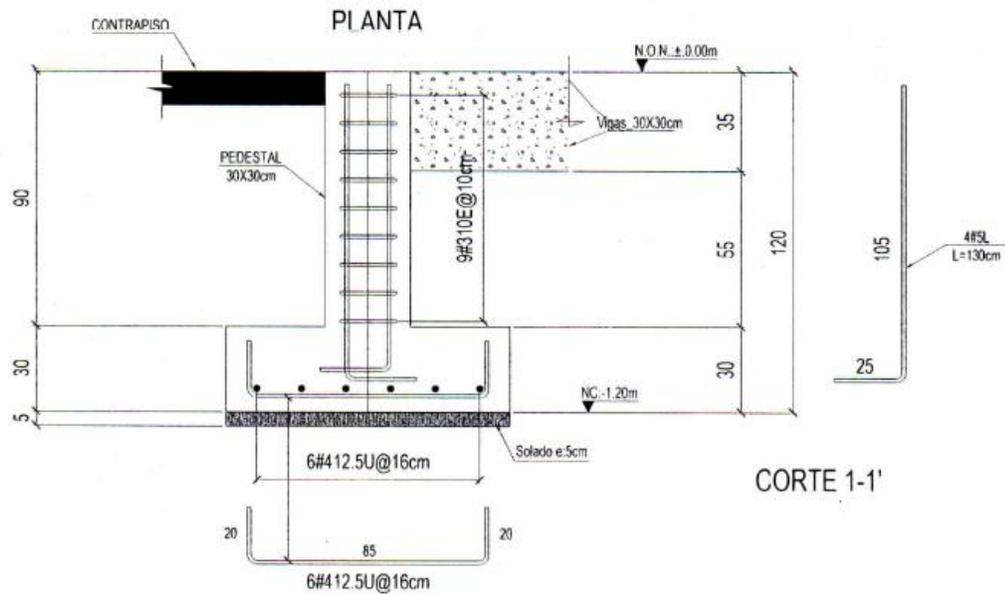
Despiece de refuerzo para zapatas de cimentación.
